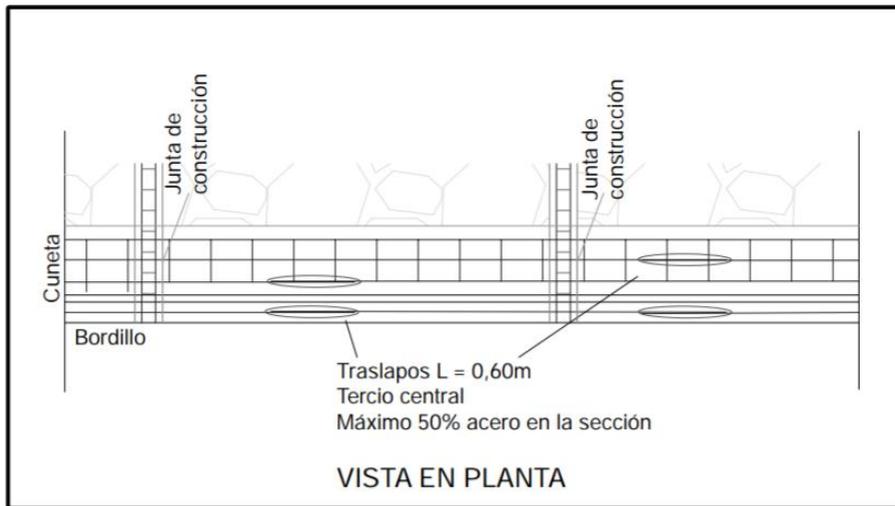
Junta Transversal de Construcción en la Berma-cuneta
